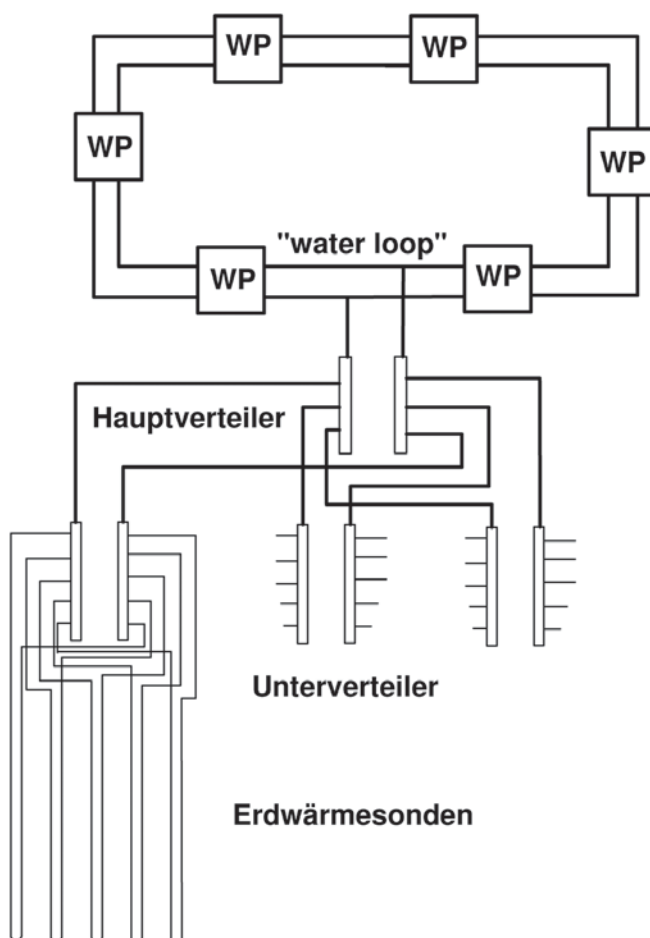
Allgemeines Schema einer „Water-Loop“-Wärmepumpenanlage mit Erdwärmesonden
